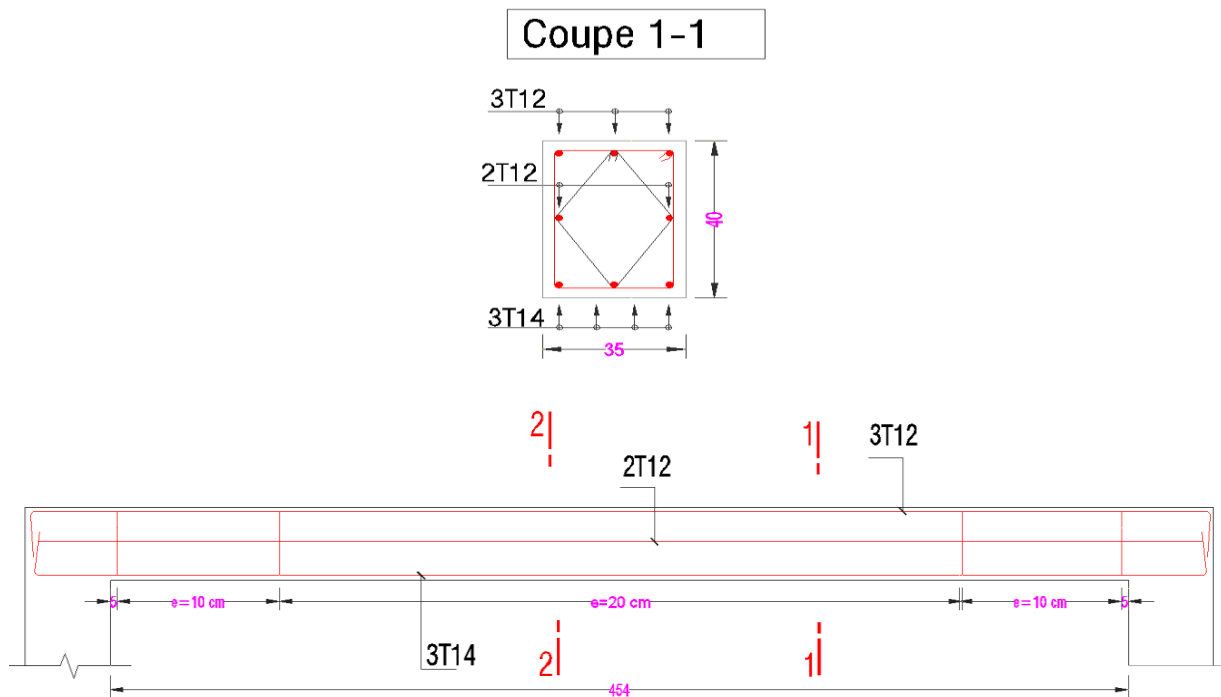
Schéma de ferrailage de la poutre palière de l'escalier d'entrée
